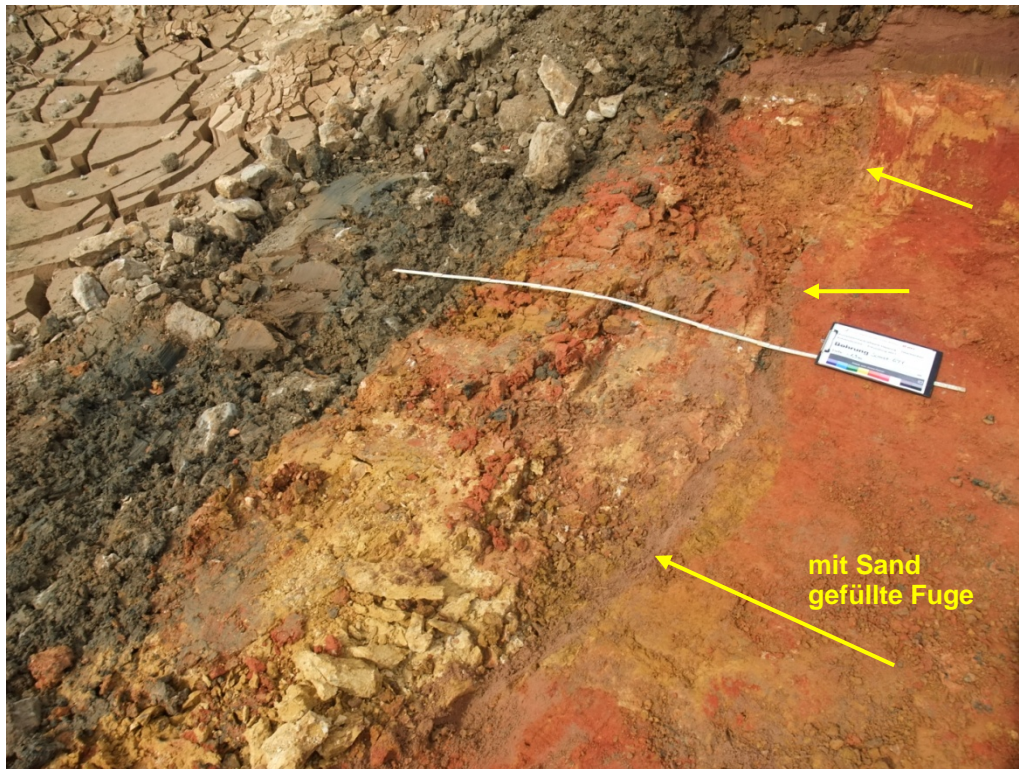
Aushub -1,9 m, nördlicher Rand Einbruchtrichter 1: Detail zu Bild 23 mit Filtersand gefüllte Spalte in kreidezeitlichen Sedimenten → Staffelbruch
